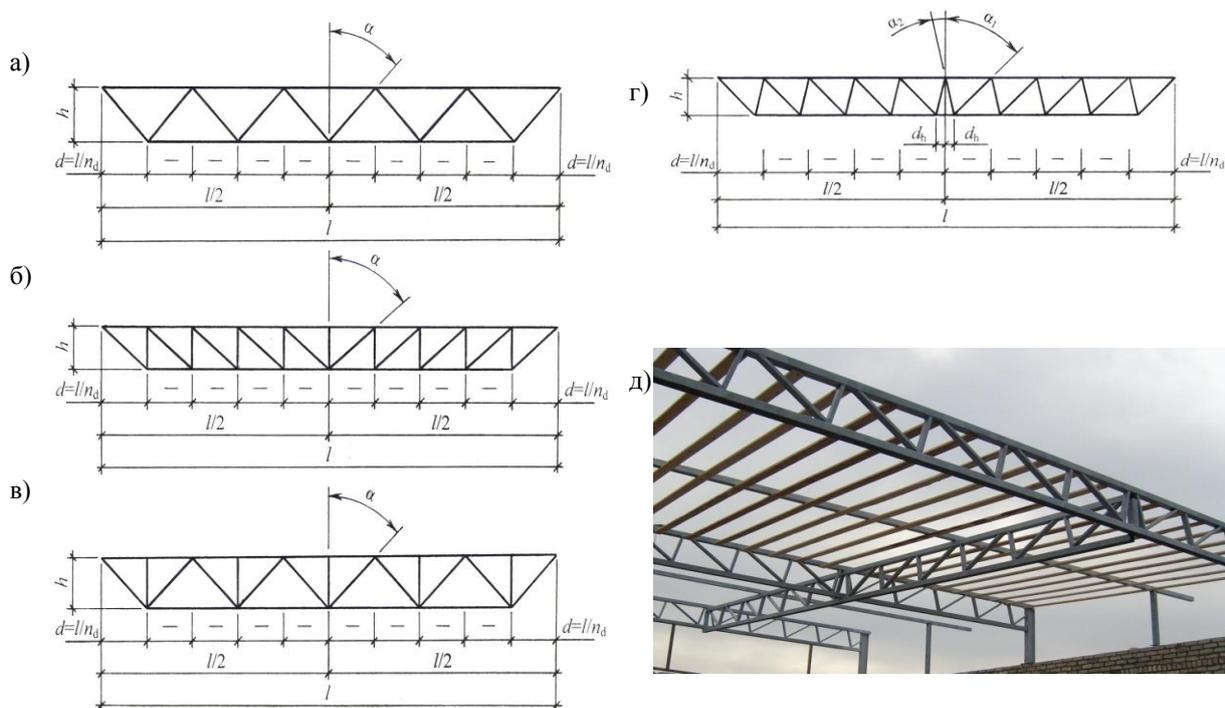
Схемы стальных ферм покрытий: а – с треугольной решеткой; б – с раскосной решеткой; в – с треугольной решеткой и дополнительными стойками; г, д – с раскосной решеткой и наклонными стойками
